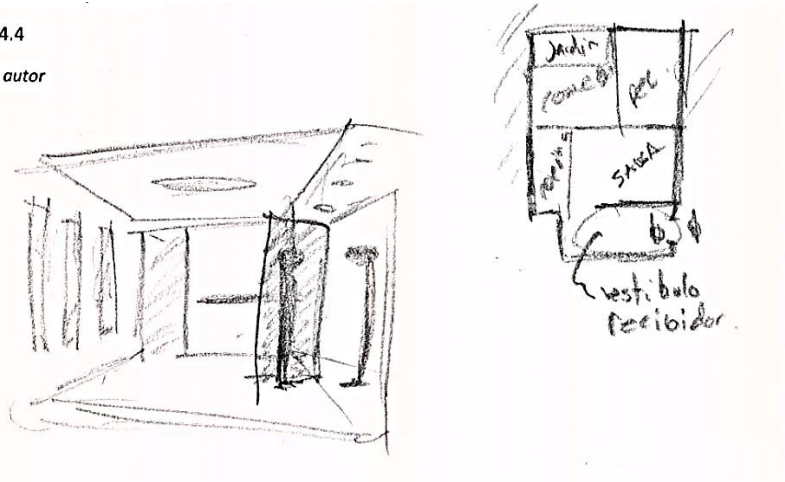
croquis de acceso a la vivienda tipo, fuente: por el autor
